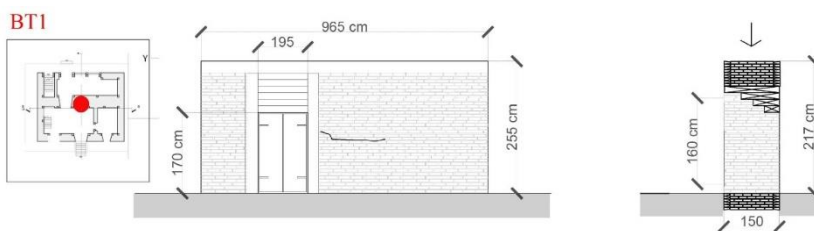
Descrizione geometrica della muratura testata nel tempio Bhimsen, piano terra
